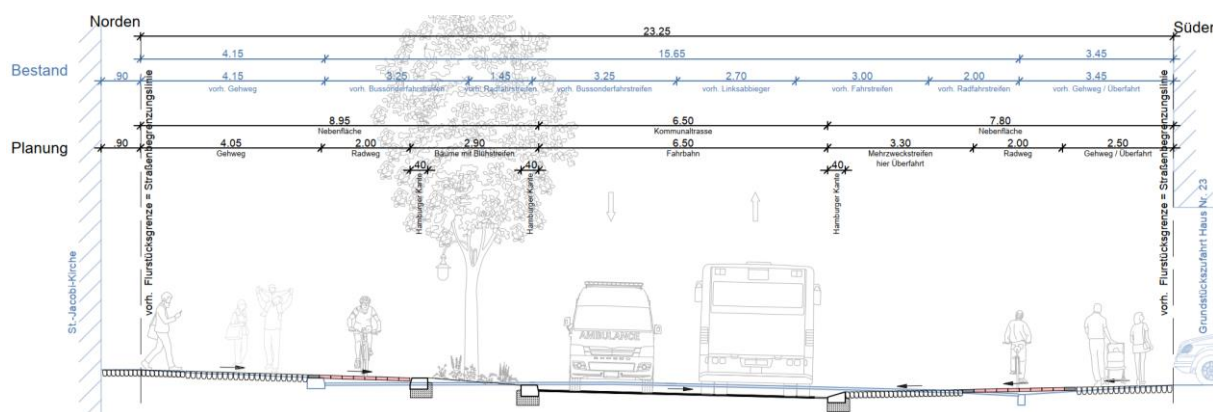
Querschnitt B-B der Ausführungsvariante (Kommunaltrasse vor Jacobi-Kirche)
